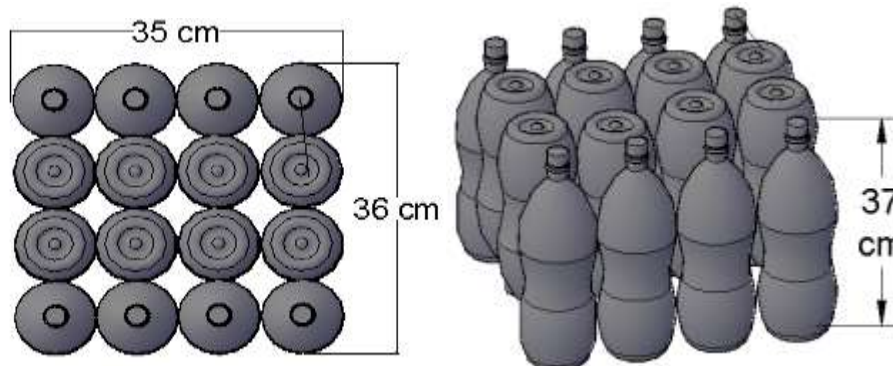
Modelo digital casetón 10 en planta y en 3D
